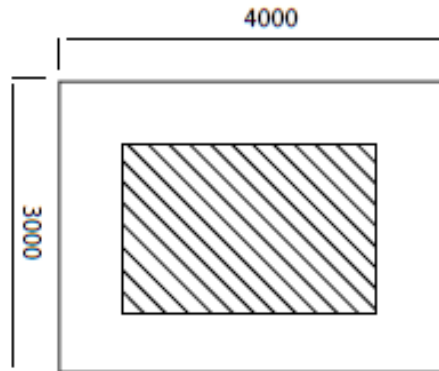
Dimensione della platea in calcestruzzo su cui installare l’impianto Mini.
